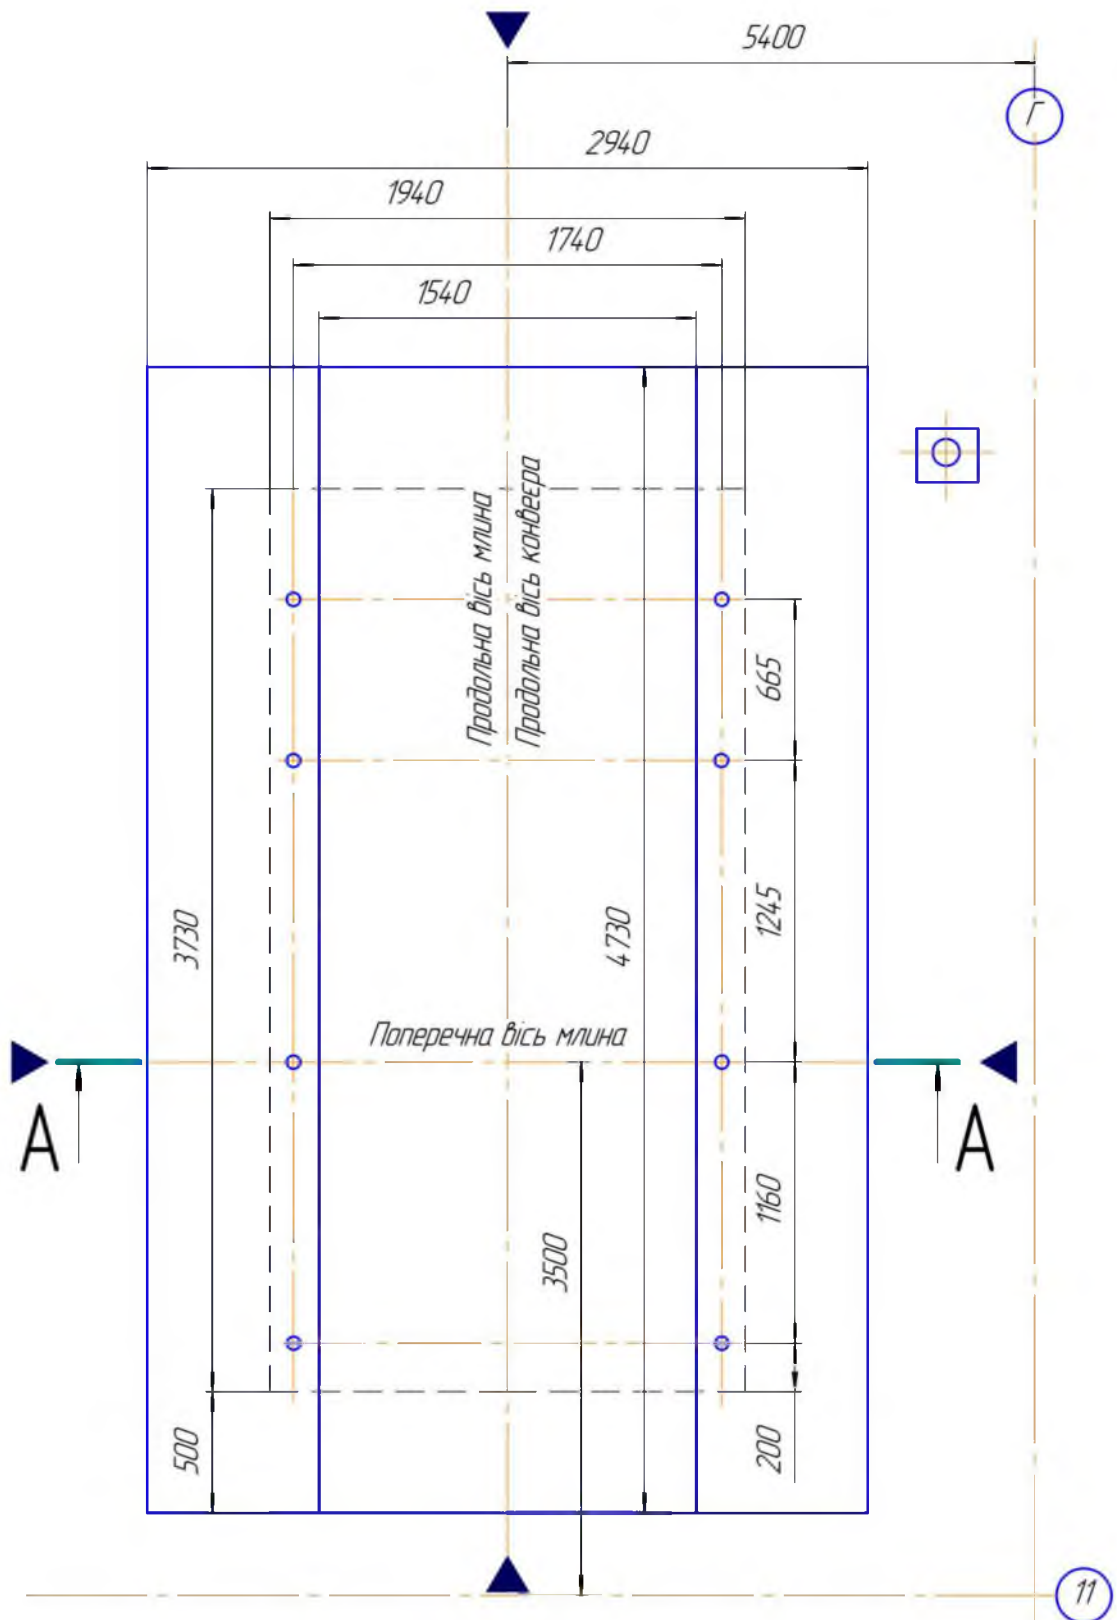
Геодезичне обґрунтування монтажу машини в плані
